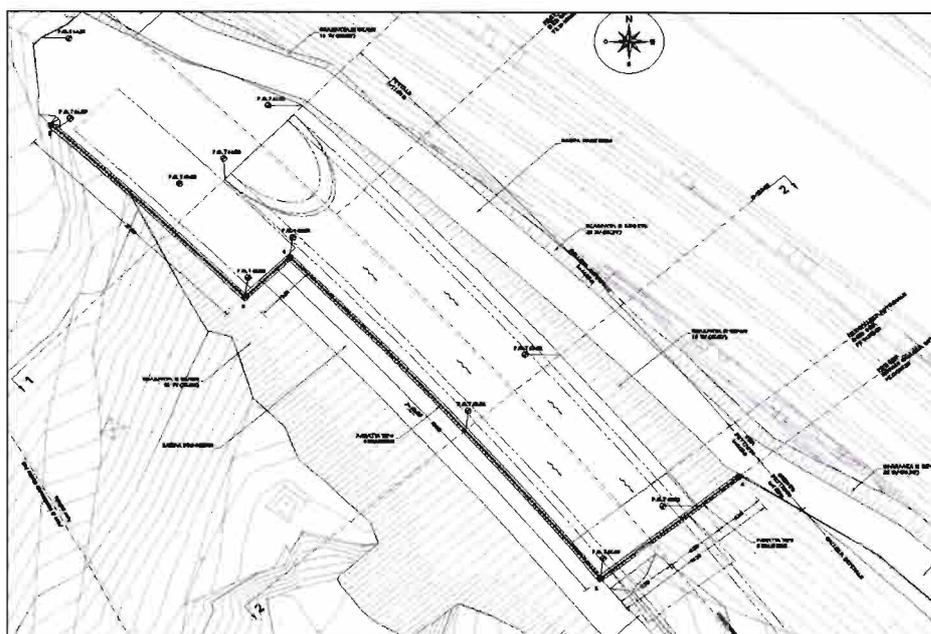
Stralcio planimetrico dell'imbocco dell'interconnessione dispari.
